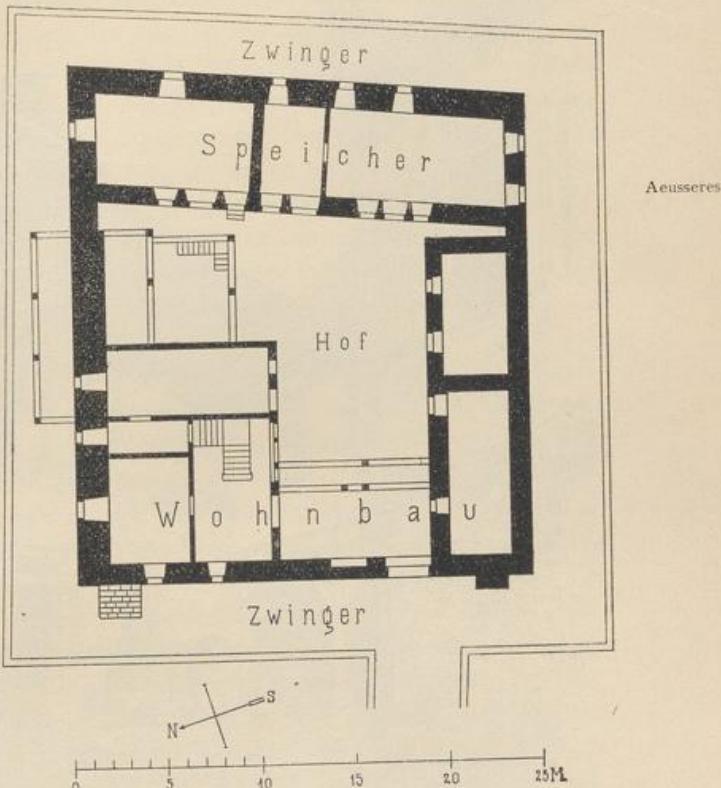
Kürnbach. Schlösschen. Grundriss des Wohnbaues.
